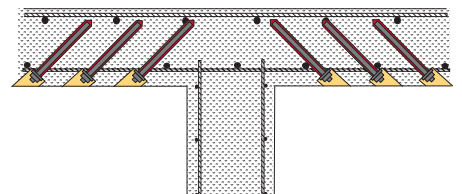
von unten eingebohrte nachträgliche Durchstanzbewehrung
